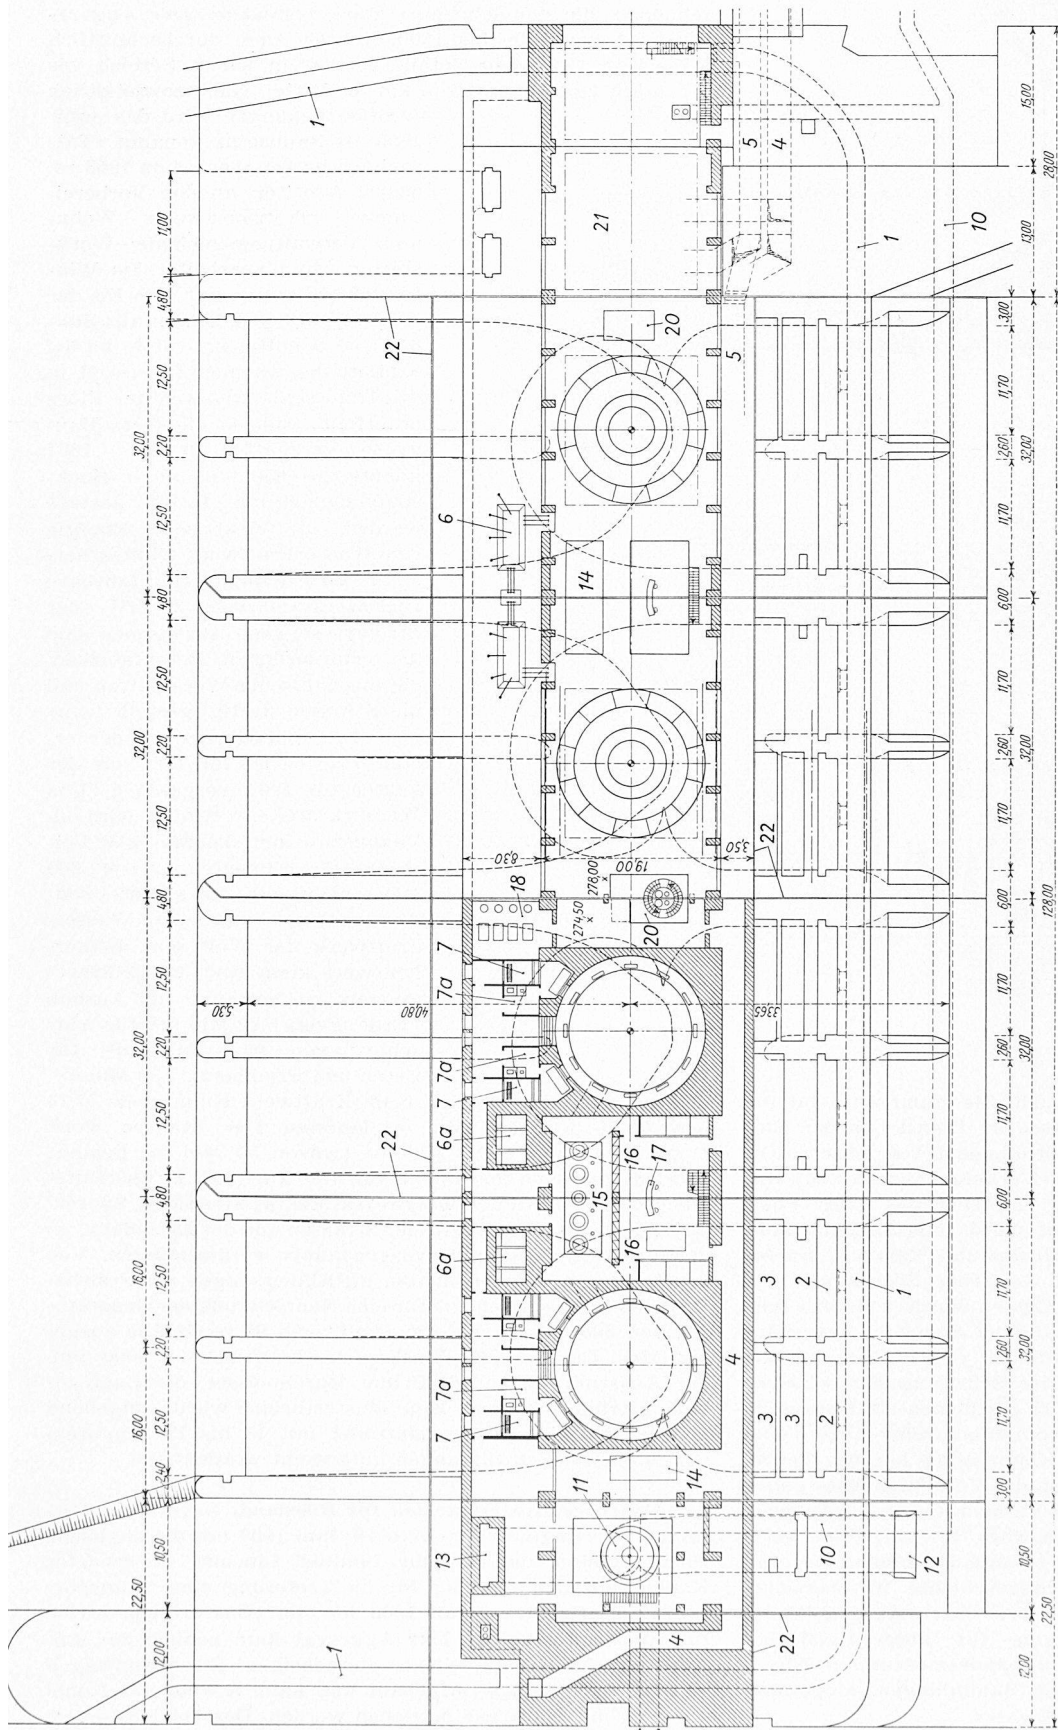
Grundriss des Kraftwerks. 1:800. Links Schnitt über Kote 274.50; rechts Schnitt über Kote 282.00.
